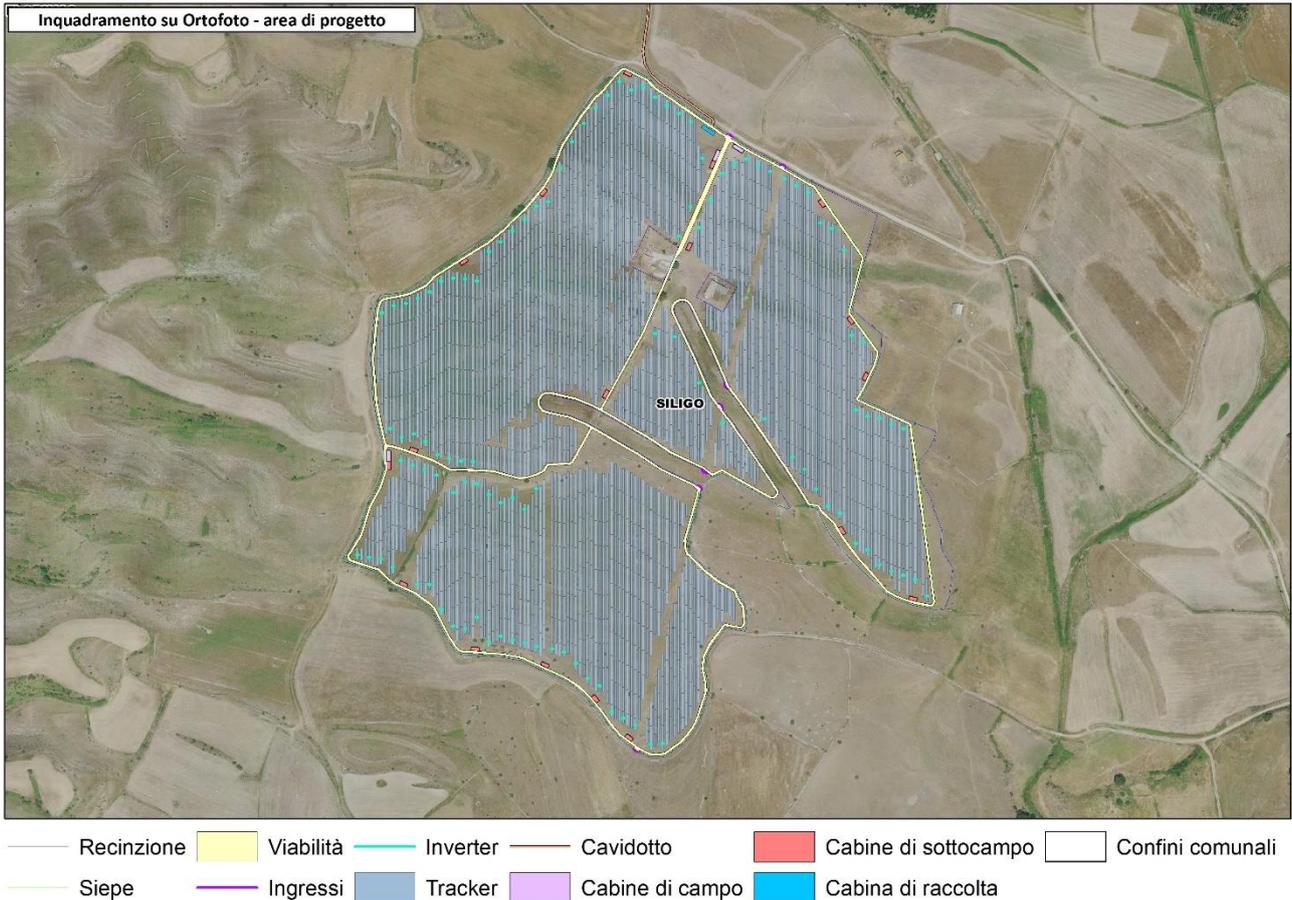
inquadramento su ortofoto - vista di dettaglio.
